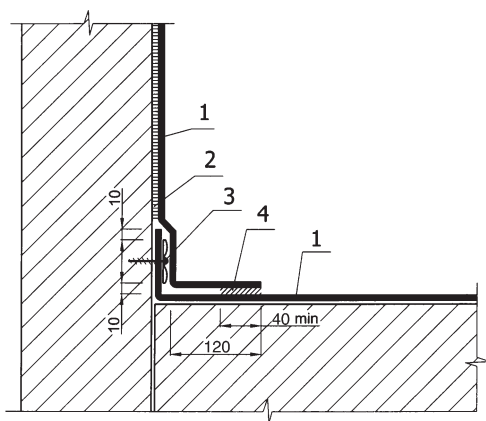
Примыкание кровли к парапету, стене (Вариант 1)
